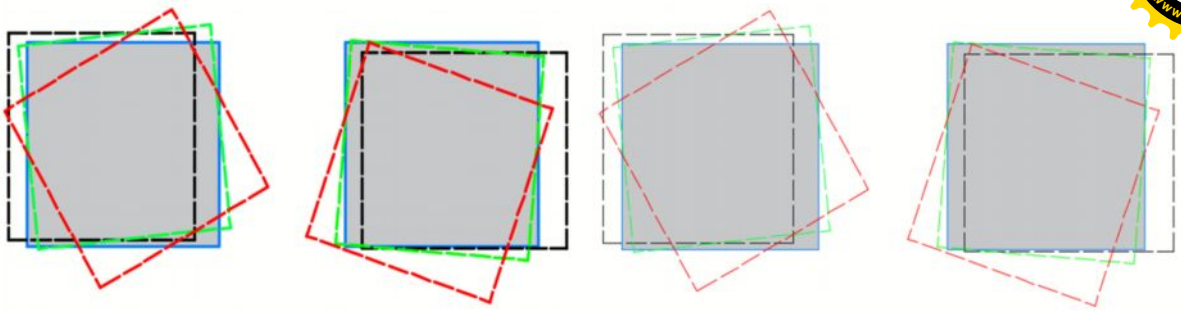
Схемы горизонтальных деформаций покрытия платформы в плане на этапах испытаний 4 и 5
